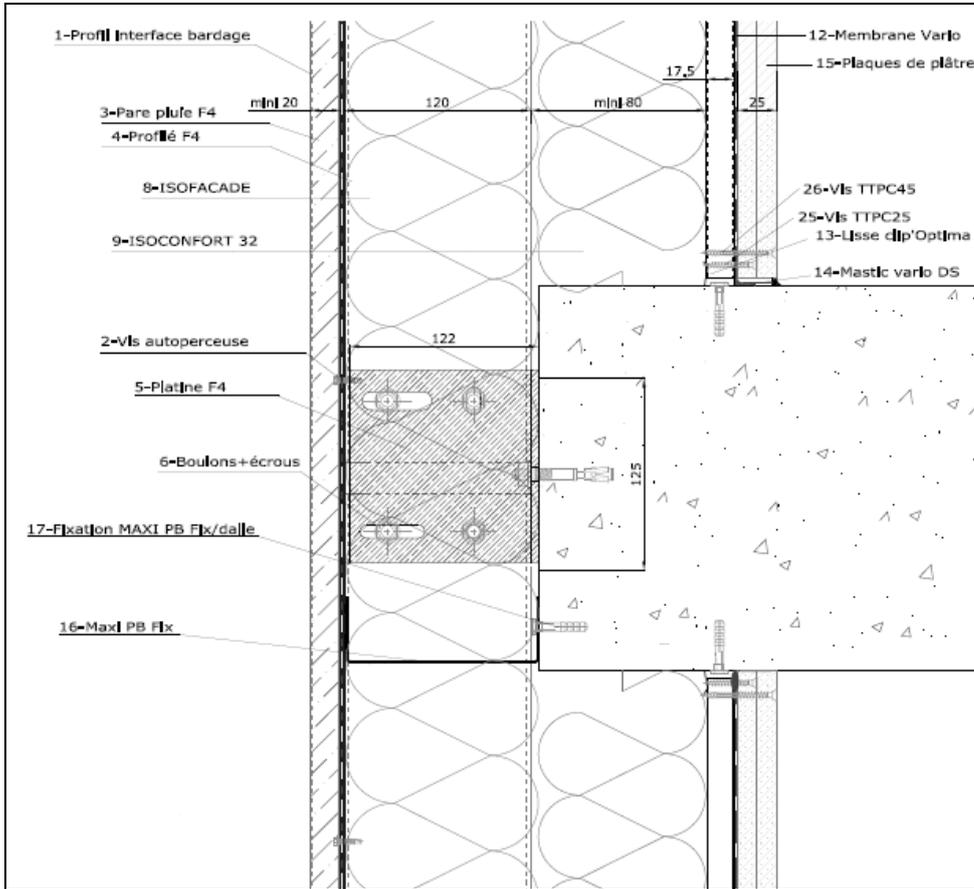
Détail coupe verticale au niveau du nez de dalle
